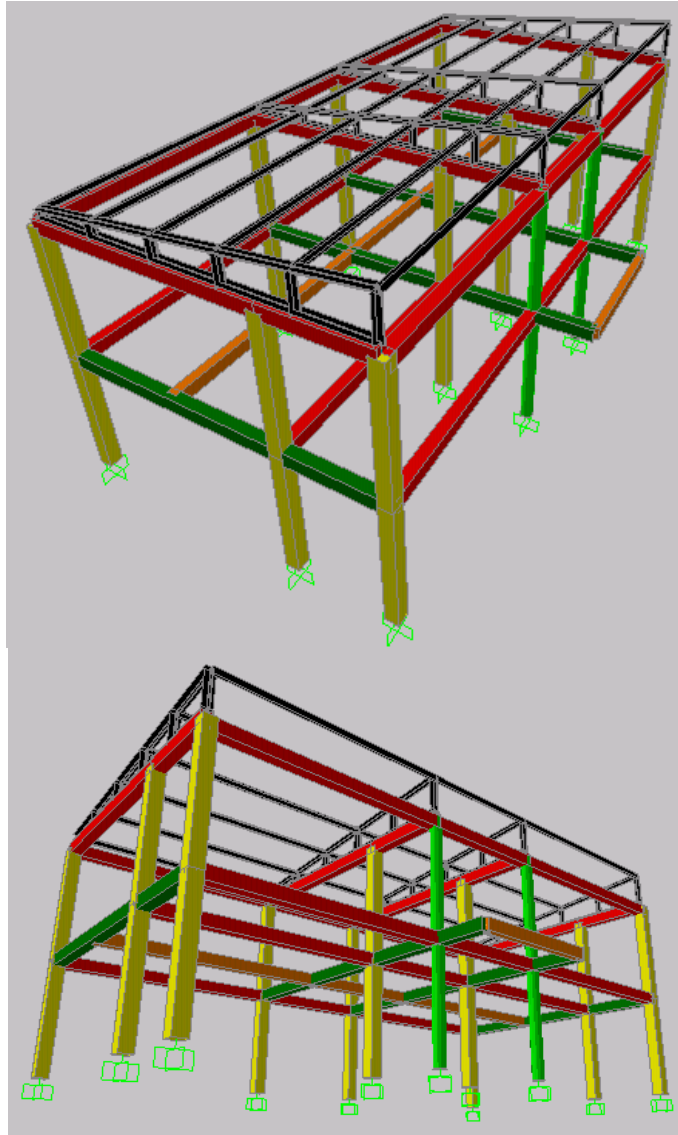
Detalle de modelación de cubierta bloque tres (ejes y secciones)
